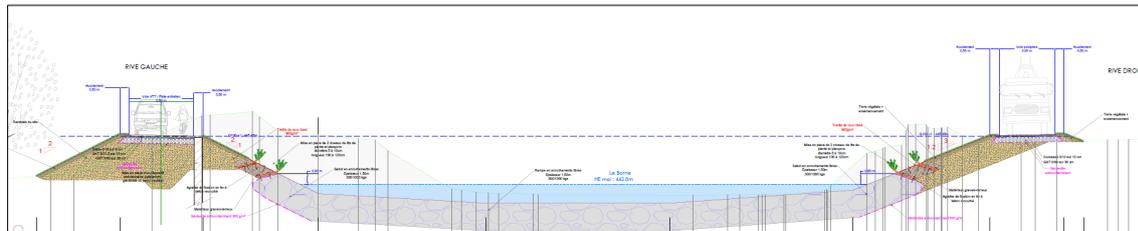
Profil en travers au droit de la double rampe (rampe aval) - PM373
